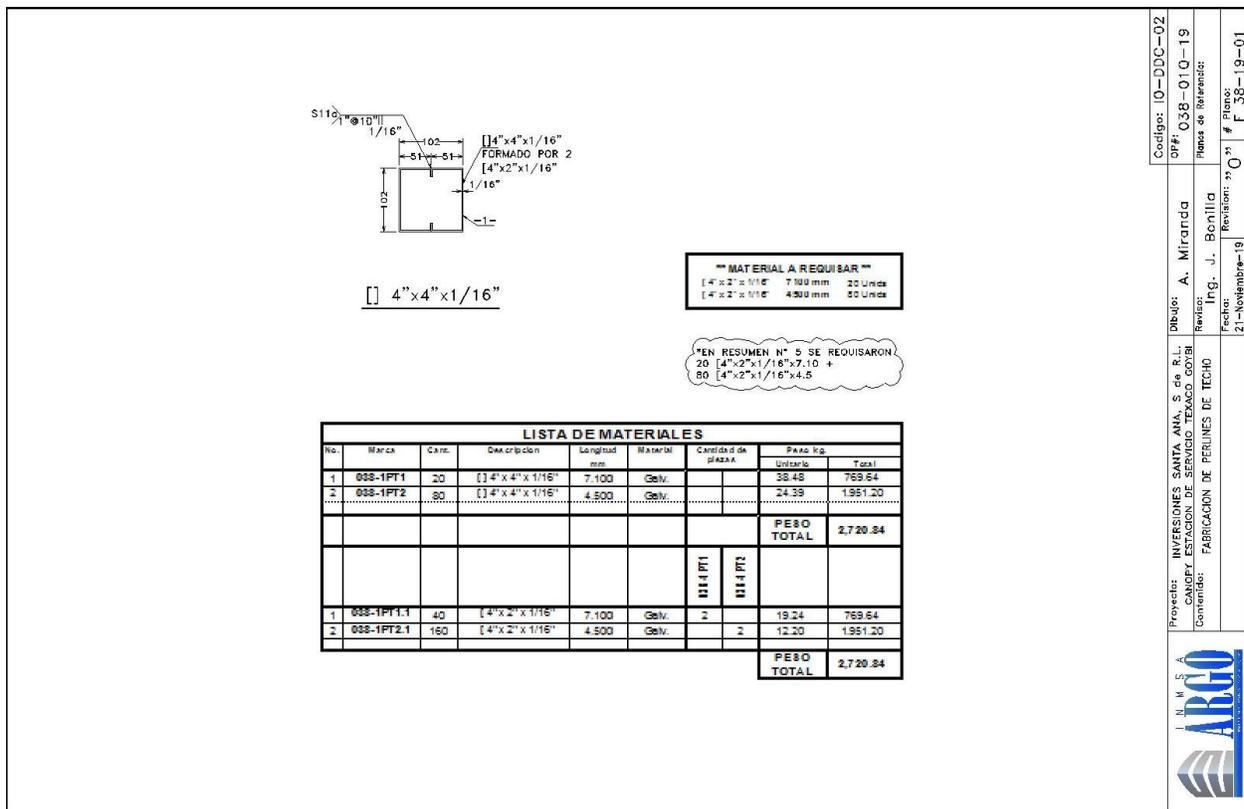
Plano de fabricación de perlines de techo para canopy mayor
